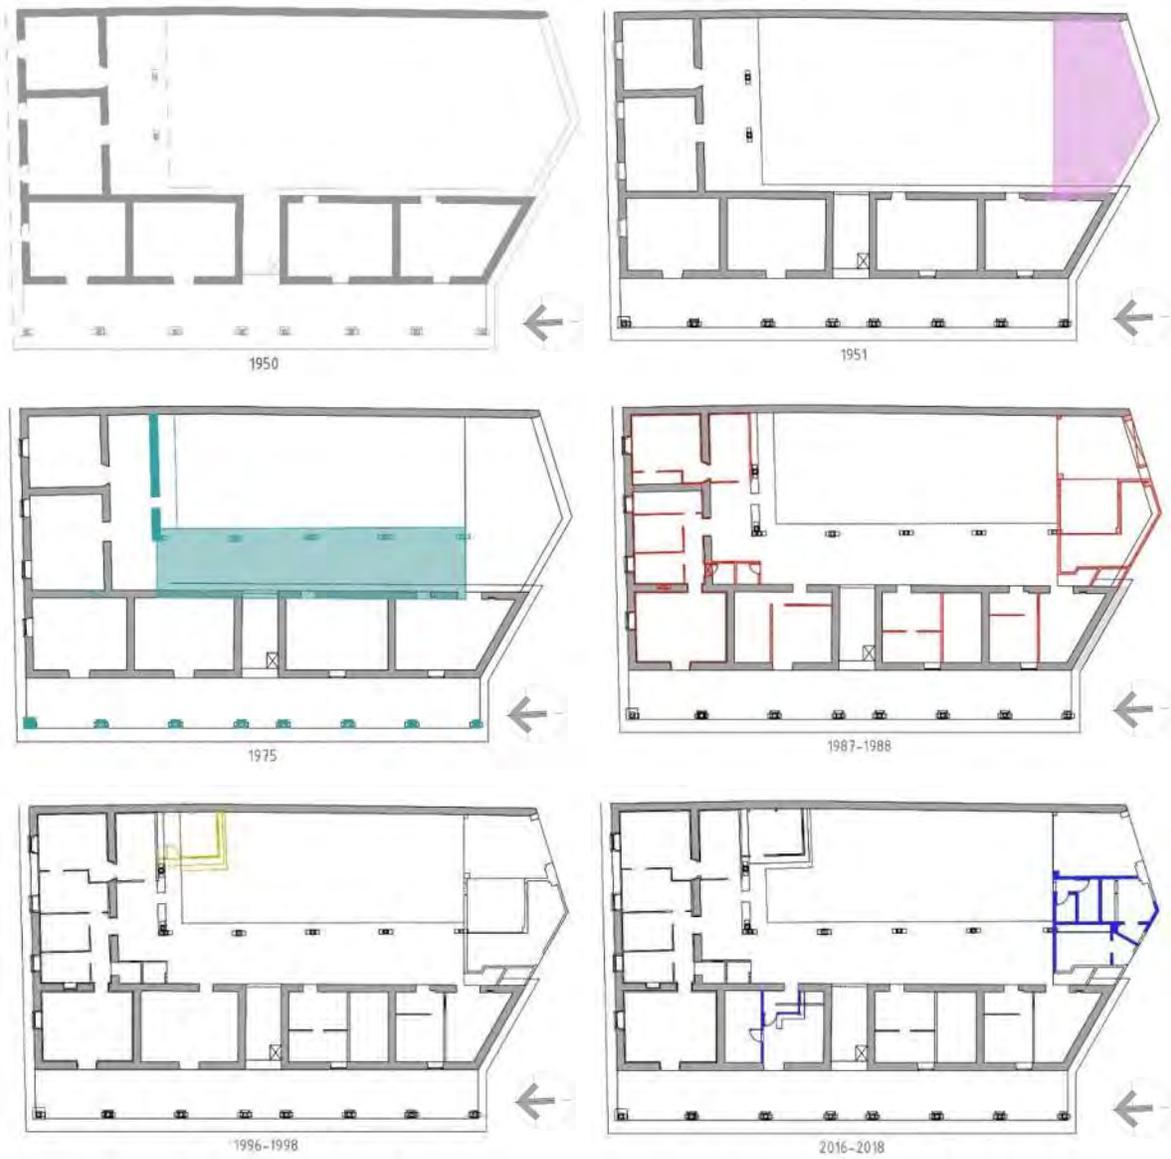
Croquis en planta de etapas de la reconstrucción histórica. Elaboró: AMT.
